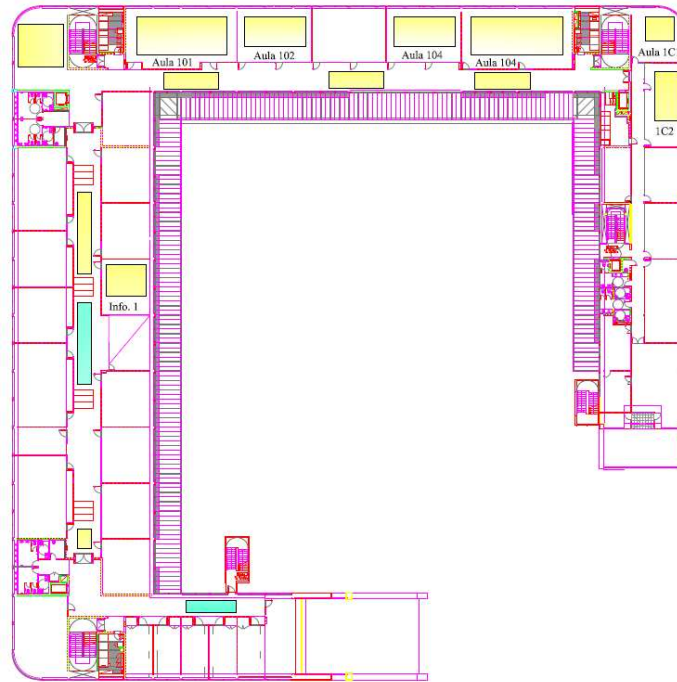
Zones mesurades de Wi-Fi en la planta 1 del TCM.
